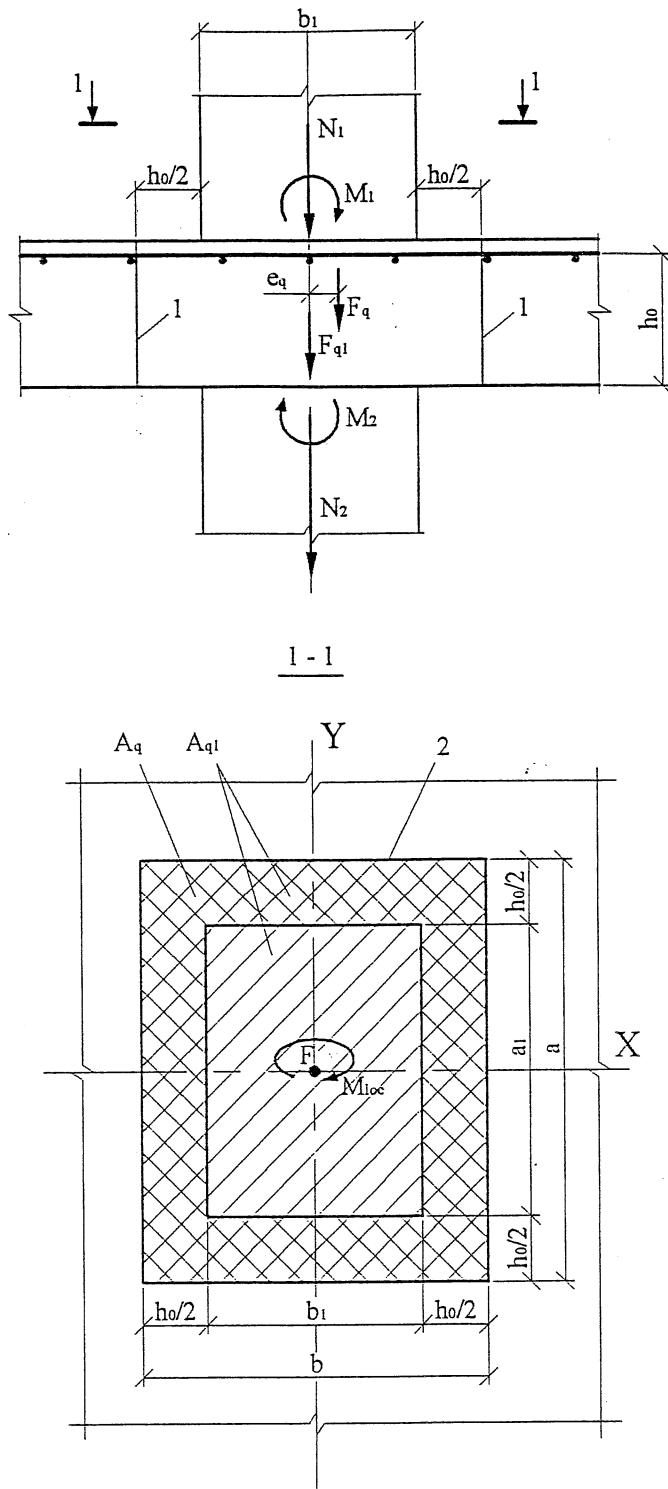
Схема для расчета железобетонных плит без поперечной арматуры на продавливание при действии сосредоточенной нормальной силы и сосредоточенного момента
